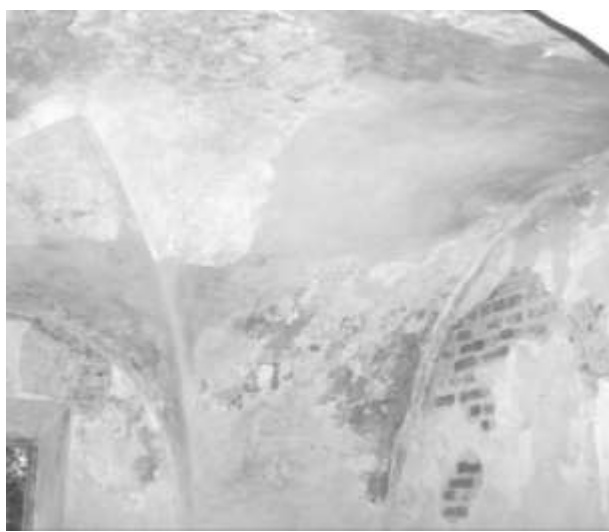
Разрушение верхних рядов кирпичной кладки стены 2-го этажа
